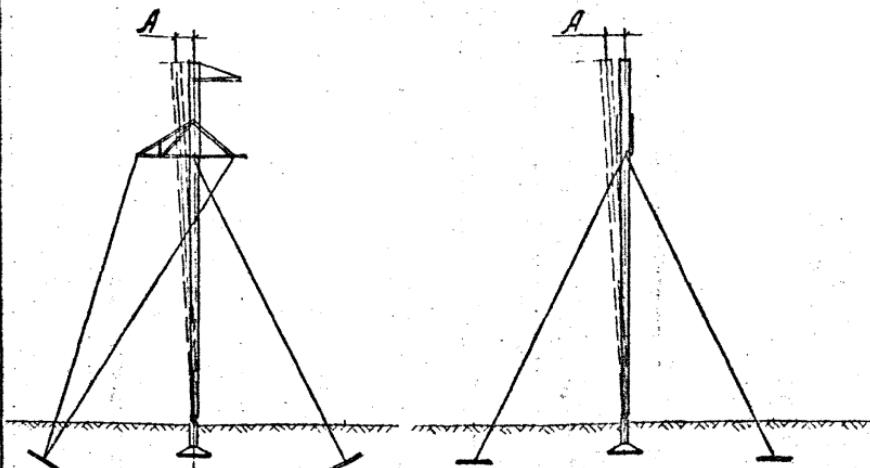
Допуски на установку одностоечных анкерно-угловых железобетонных опор
